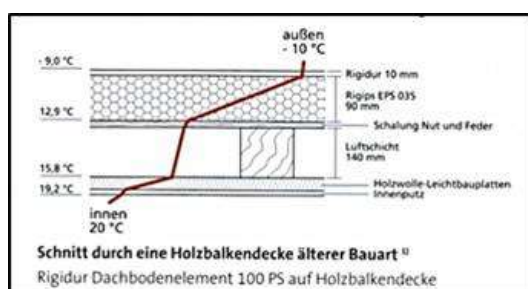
Schnitt durch eine Holzbalkendecke älterer Bauart (Quelle: Prospekt „Rigidur Dachbodenelement“)
